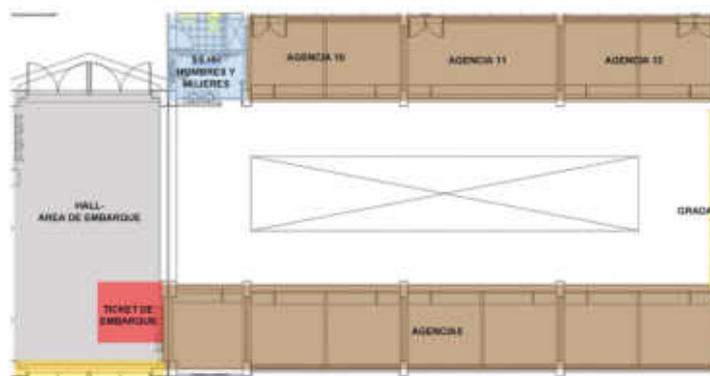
Planta de Distribución del Primer Nivel del bloque “C”.
